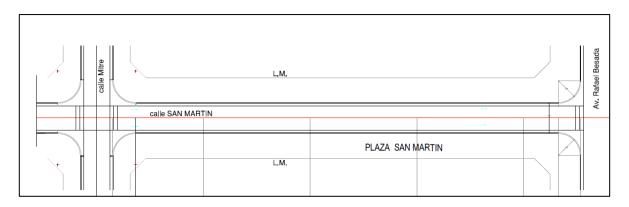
Planta tramo calle San Martín entre Mitre y Besada (s/proyecto de CAFESG)
